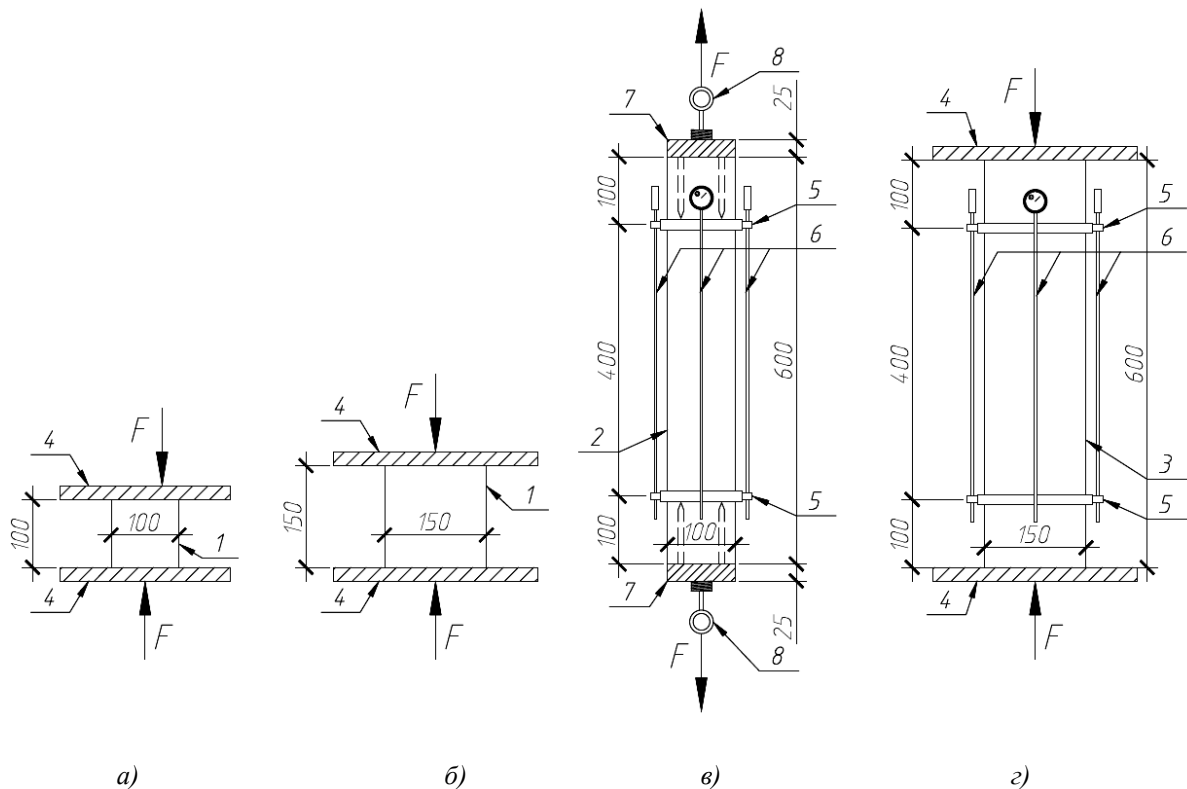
Схеми випробування і розміри дослідних бетонних зразків:
